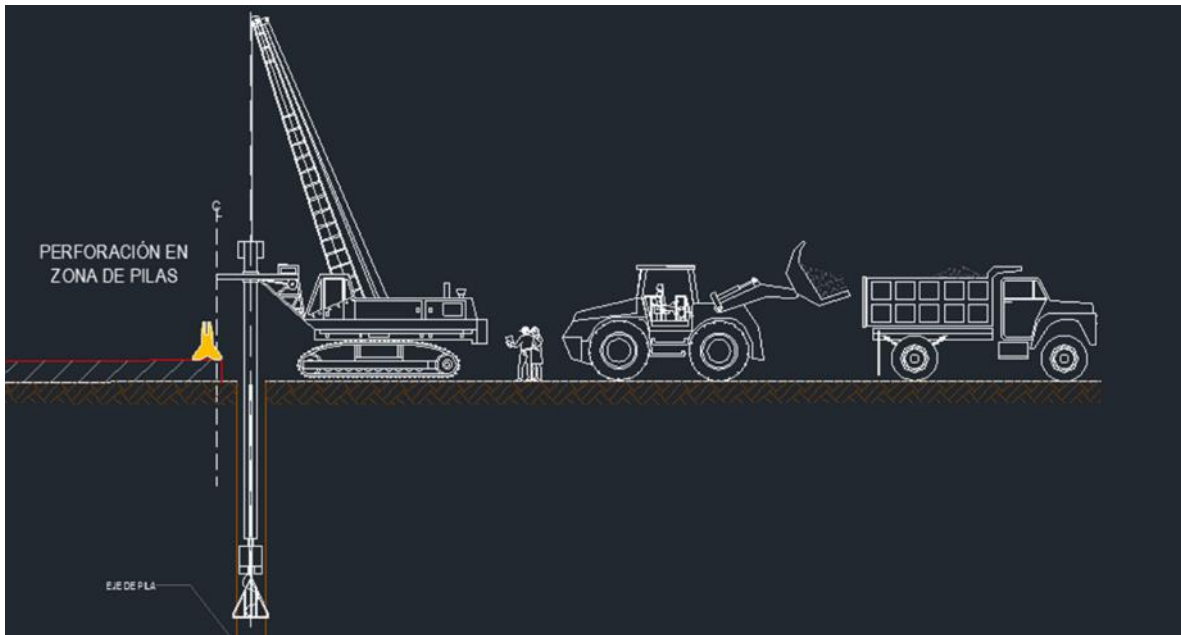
Ejemplo de la excavación para cajón de cimentación
